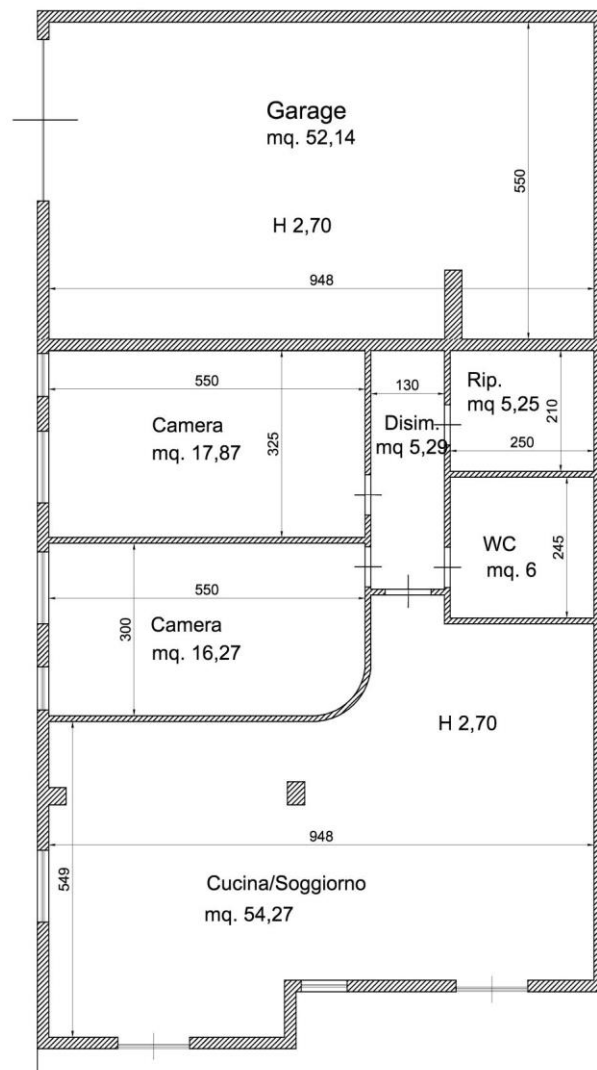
Planimetria appartamento e garage annesso – Rilievo Stato dei Luoghi
